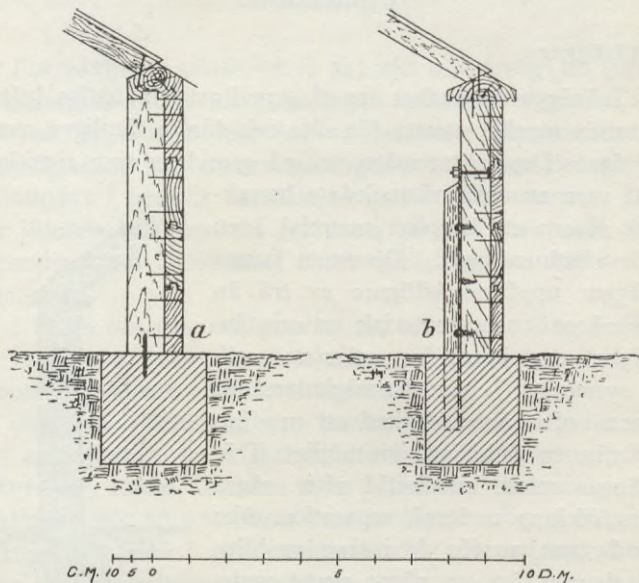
Träväggar med stolpar, fastsatta å betongpelare
